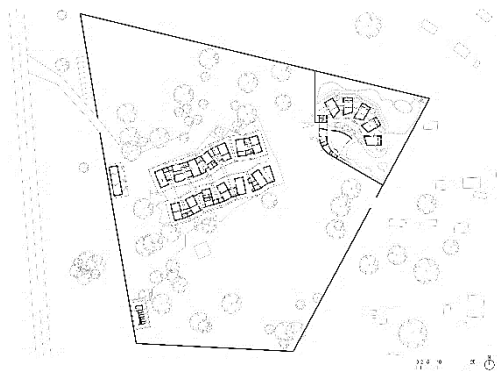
PLANTA GENERAL PROYECTO INICIAL
